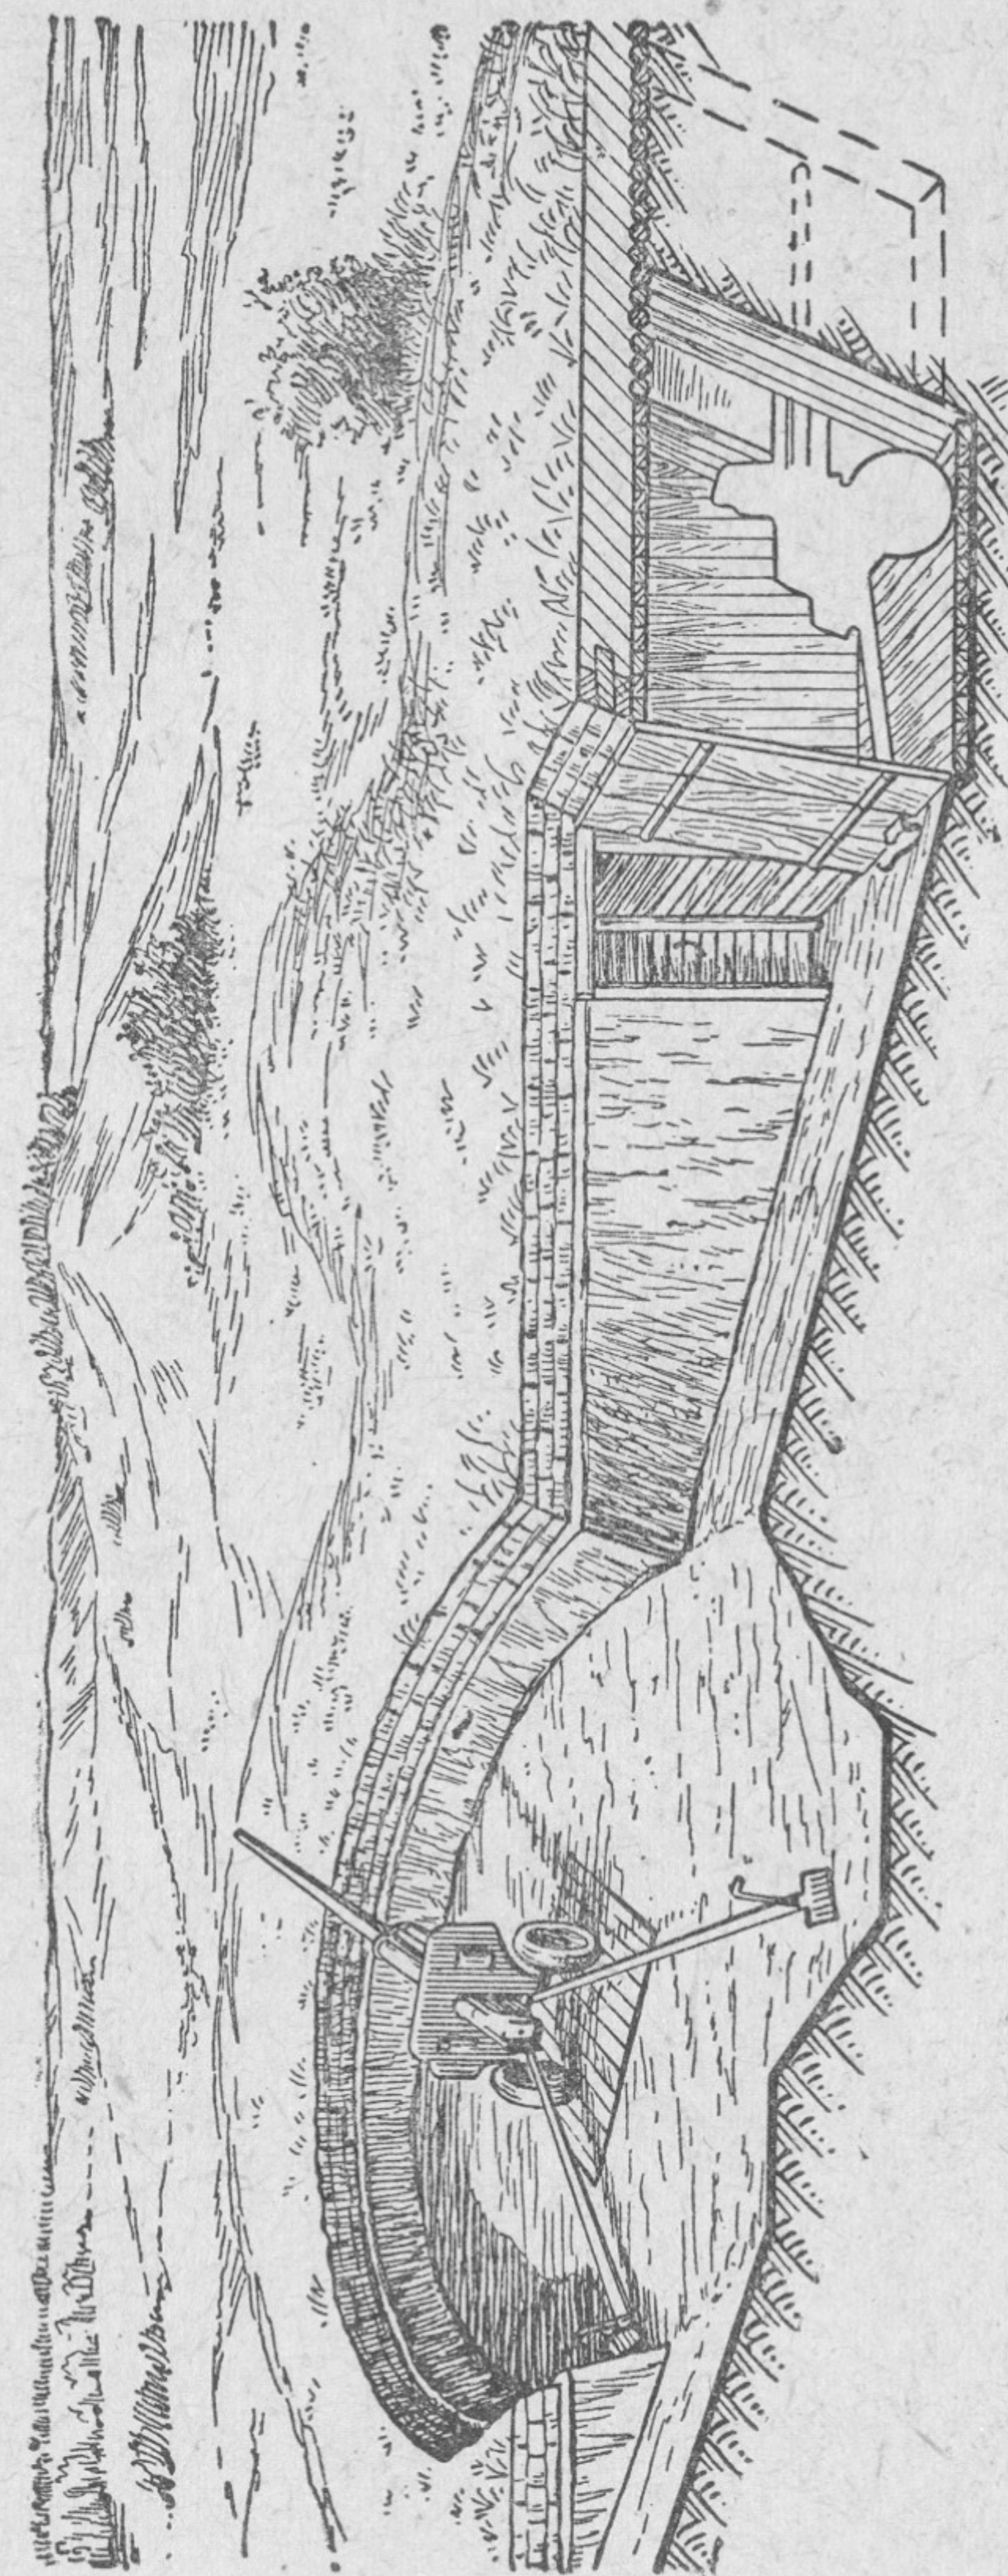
Окоп с укрытием для орудия. Рядом с укрытием виден вход в блиндаж для расчёта
